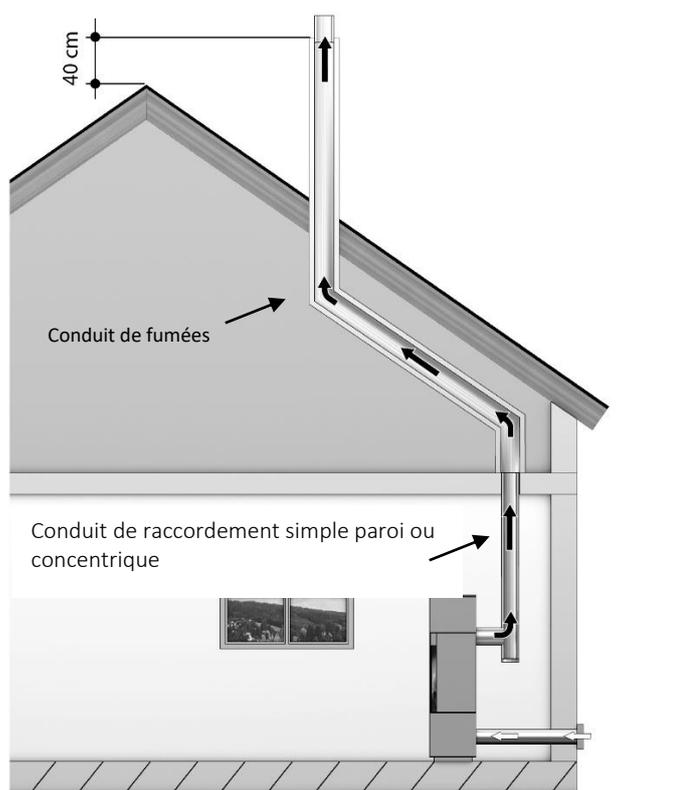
Installation étanche Zone 1 ; Conduit d'amenée d'air extérieur
